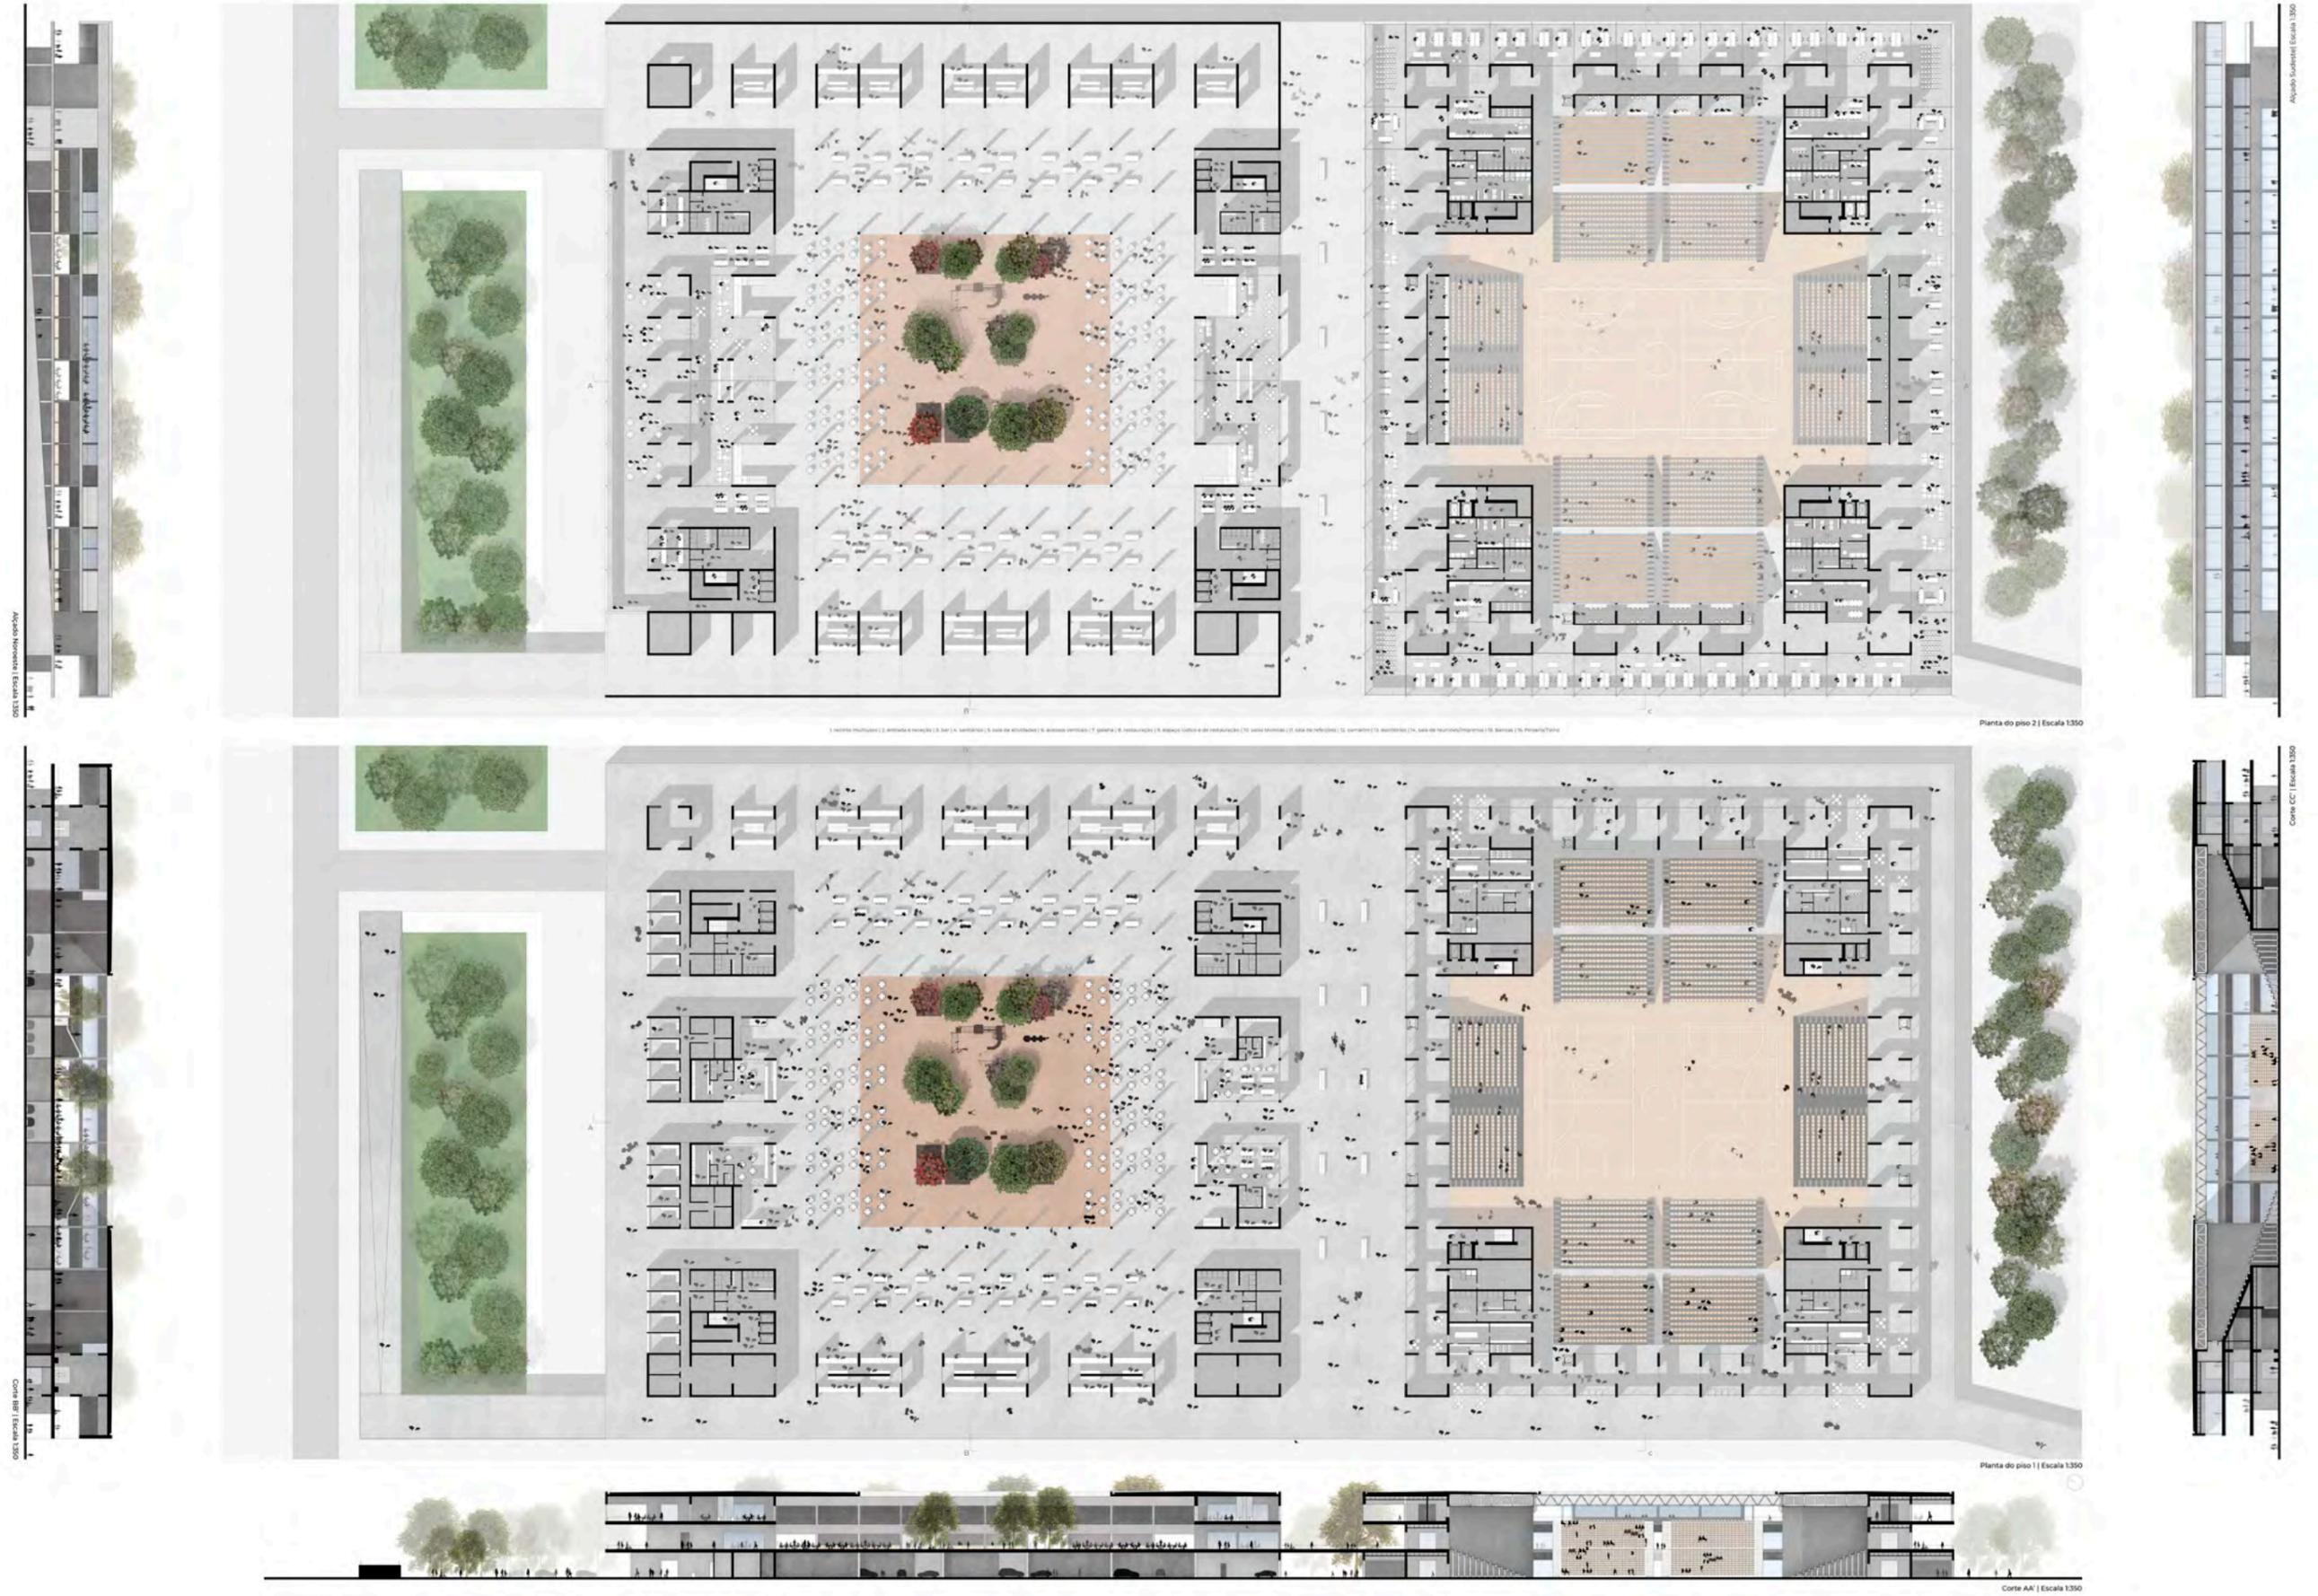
| Proposta Individual: Planta pisos 1 e 2 | Alçados e Cortes (ver Painel A0 em anexo)
